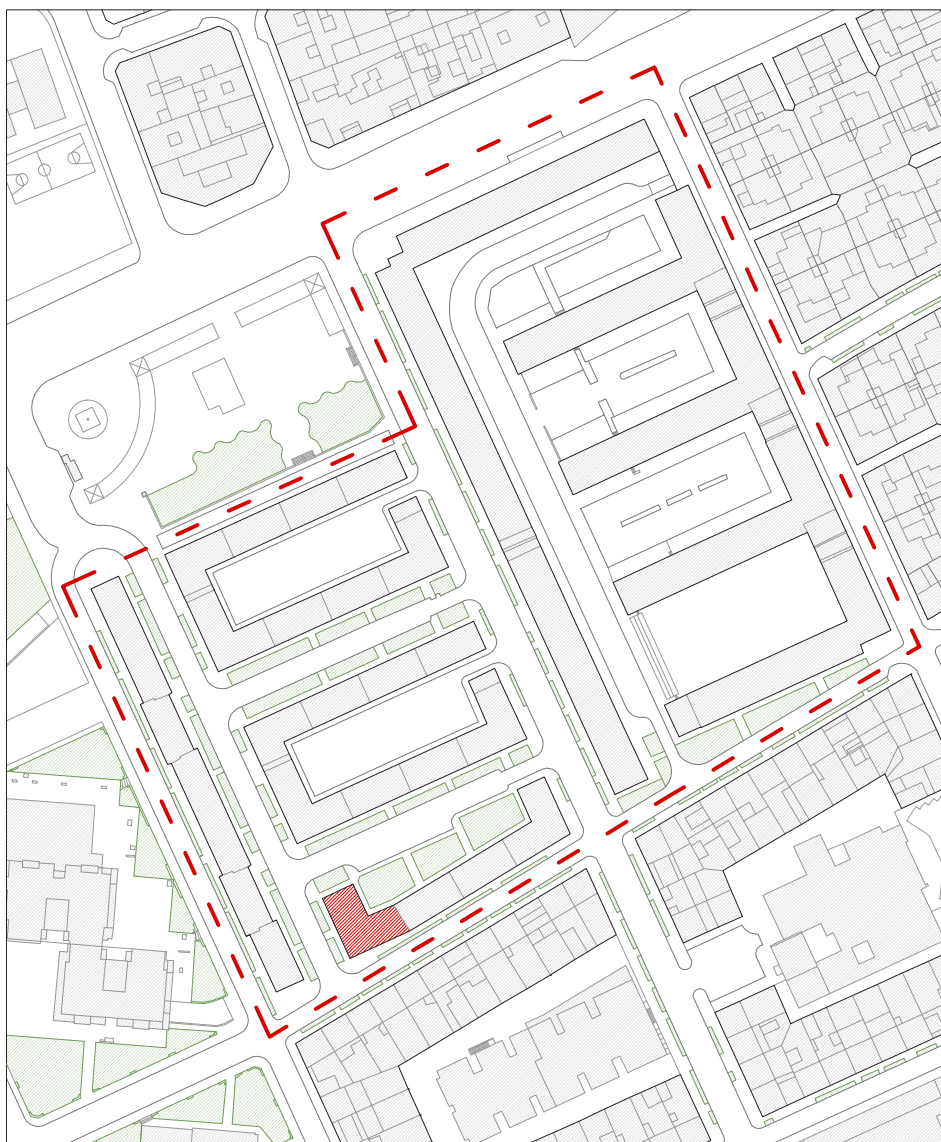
Plano de emplazamiento del caso de estudio (e: 1/2.000).
